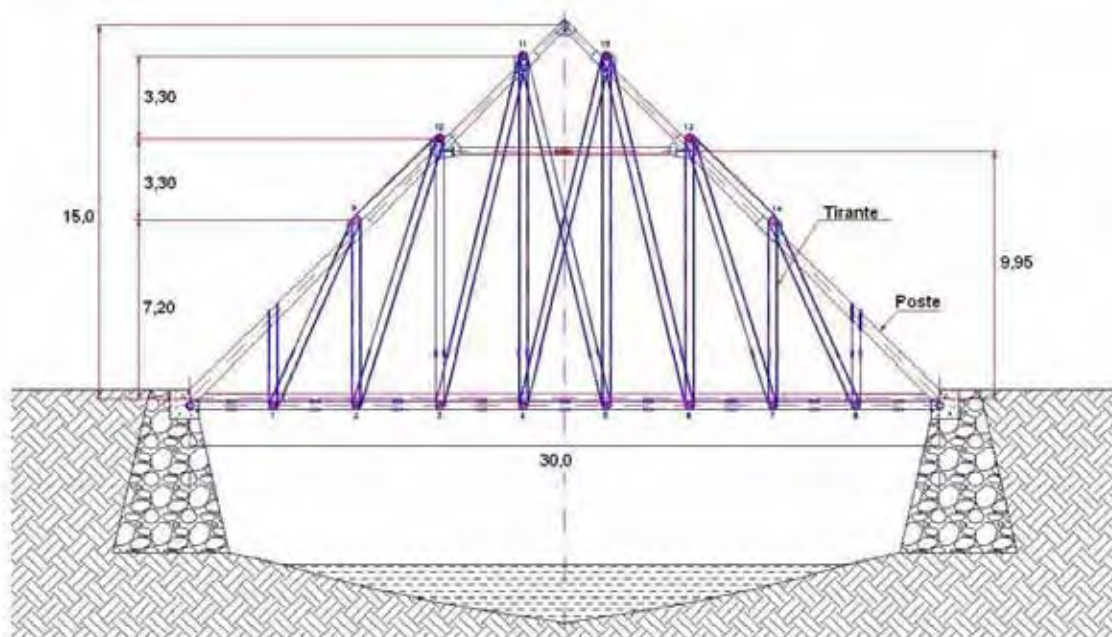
Vista lateral da ponte com estrutura aporticada.
